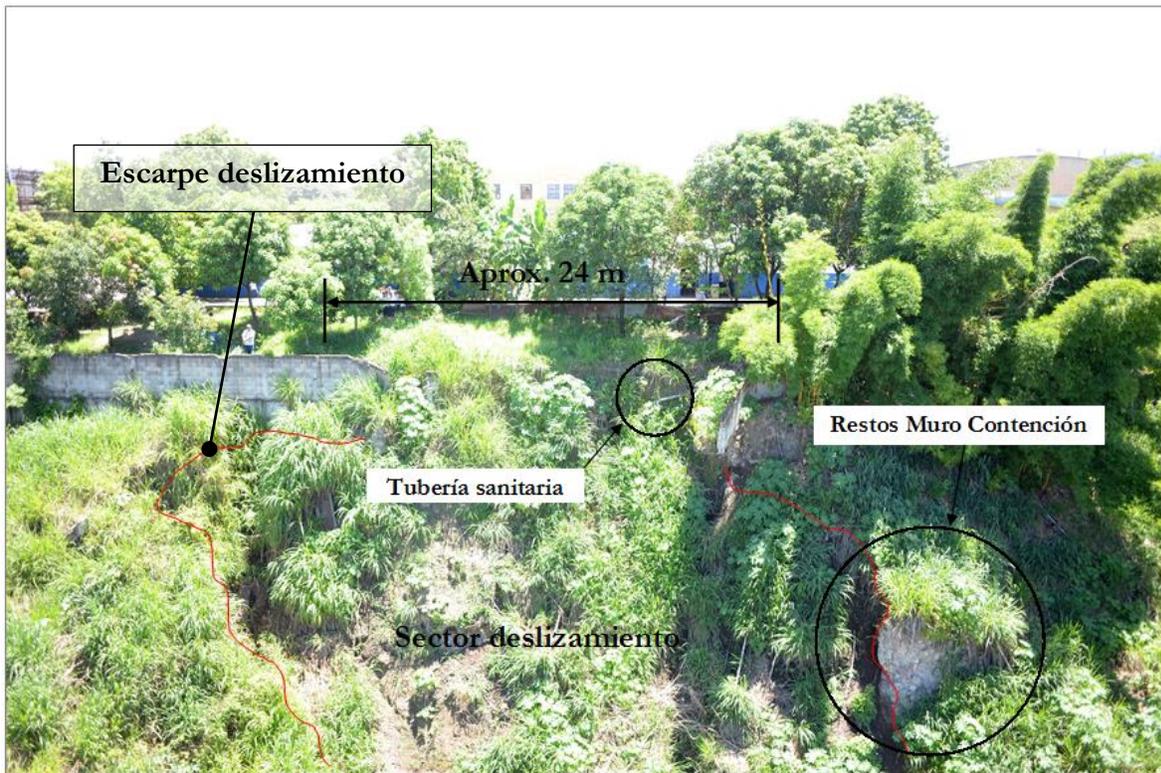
Vista aérea de sector de muro colapsado en lindero poniente del Centro Escolar Monseñor Plantier.
